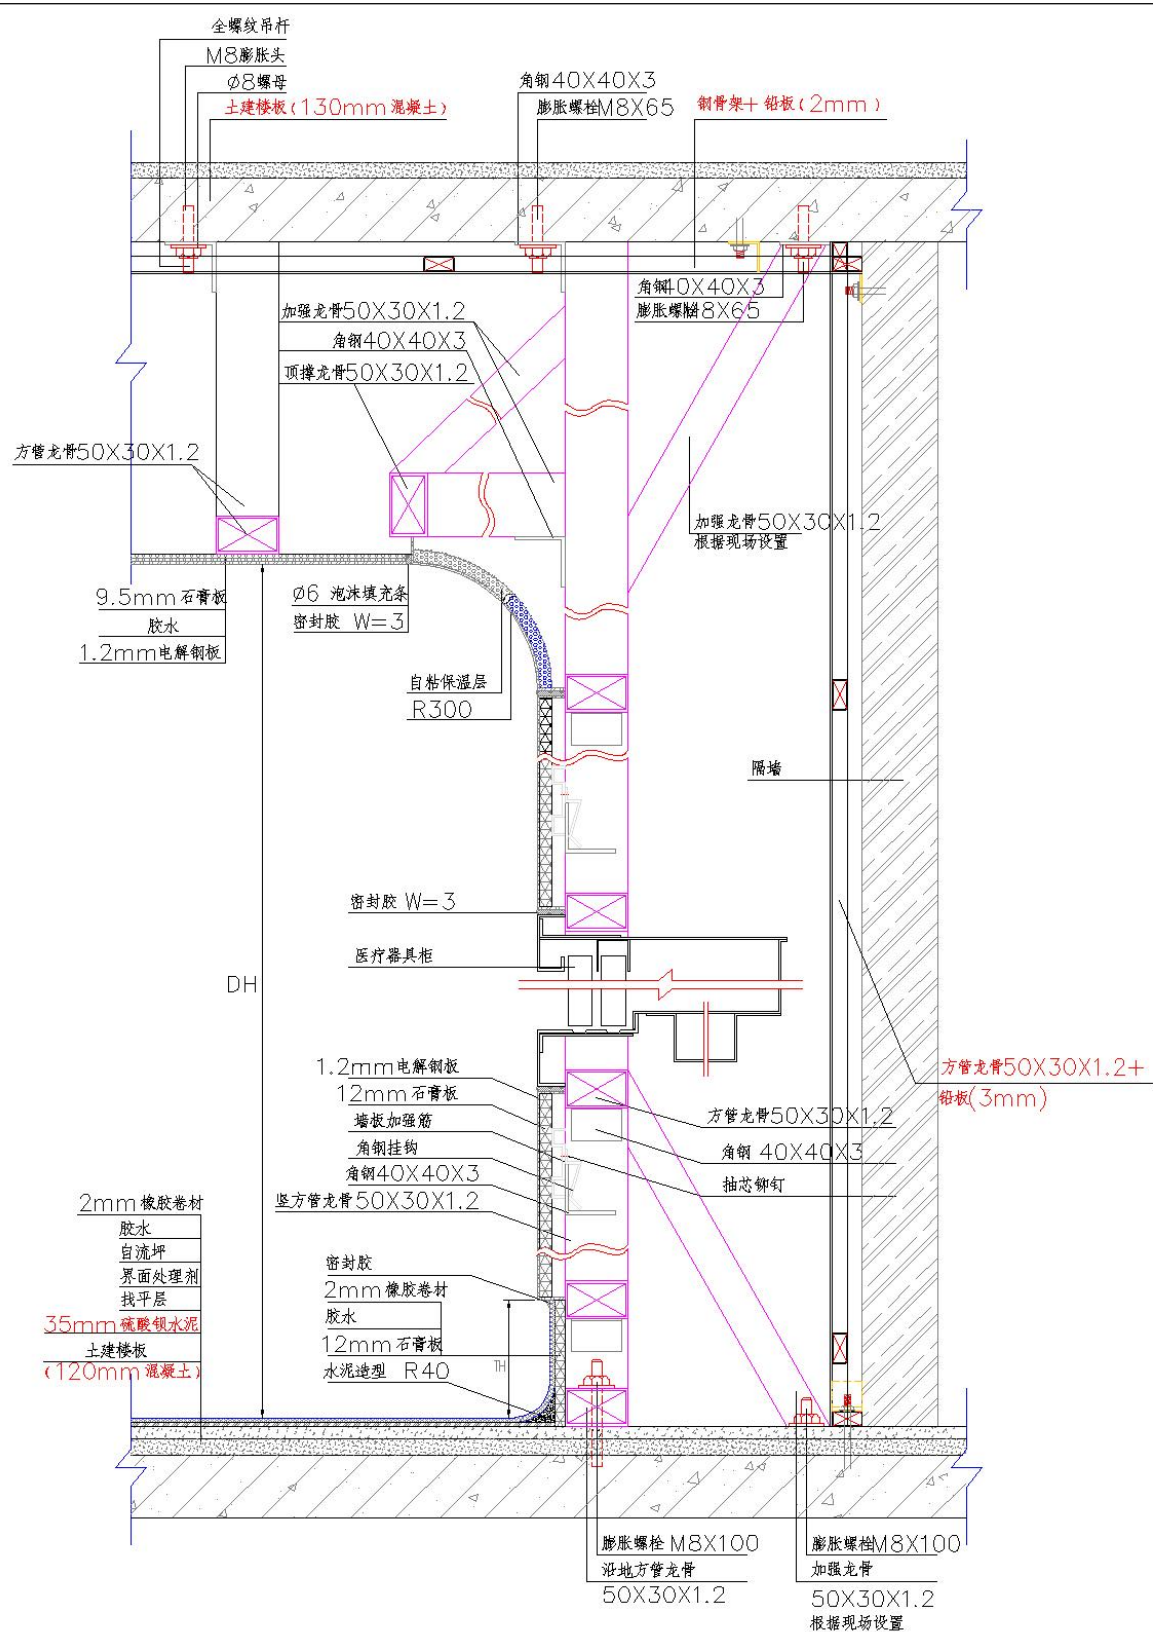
DSA 机房墙体、地板、顶板结构示意图
